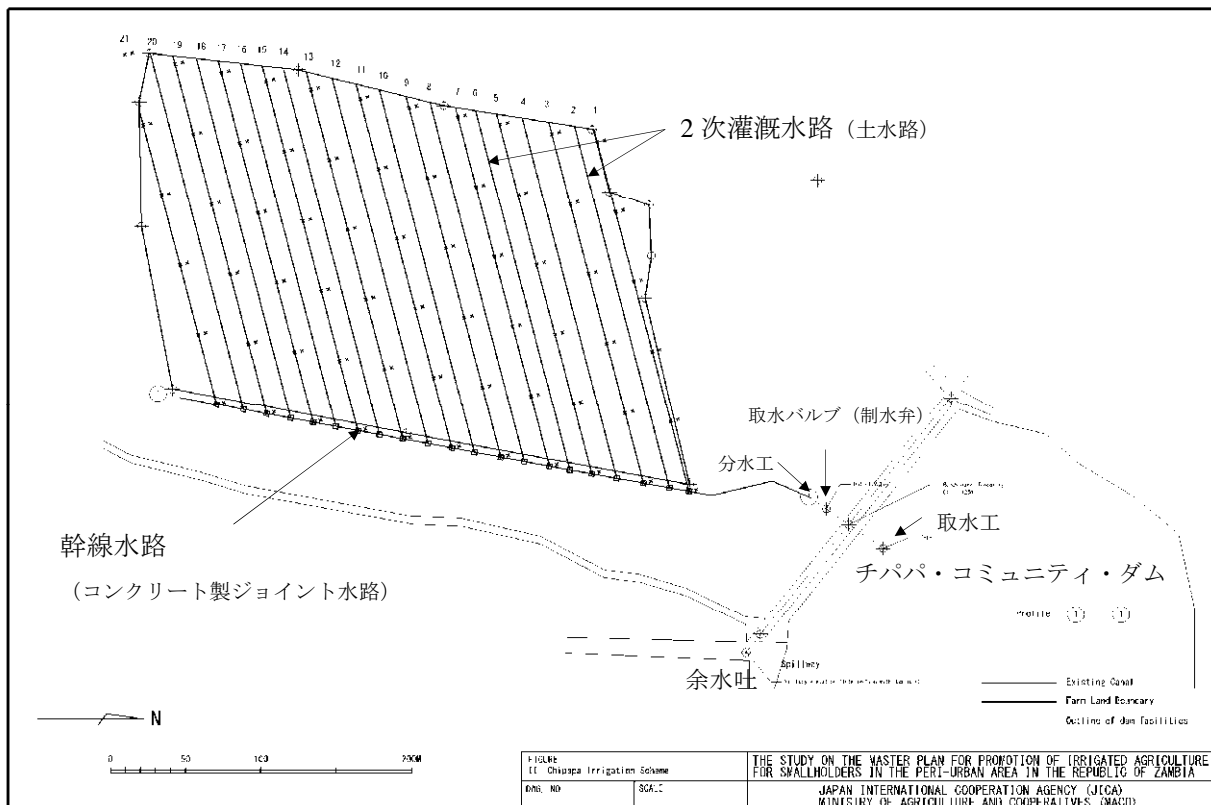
チパパ灌漑スキーム灌漑施設配置図
